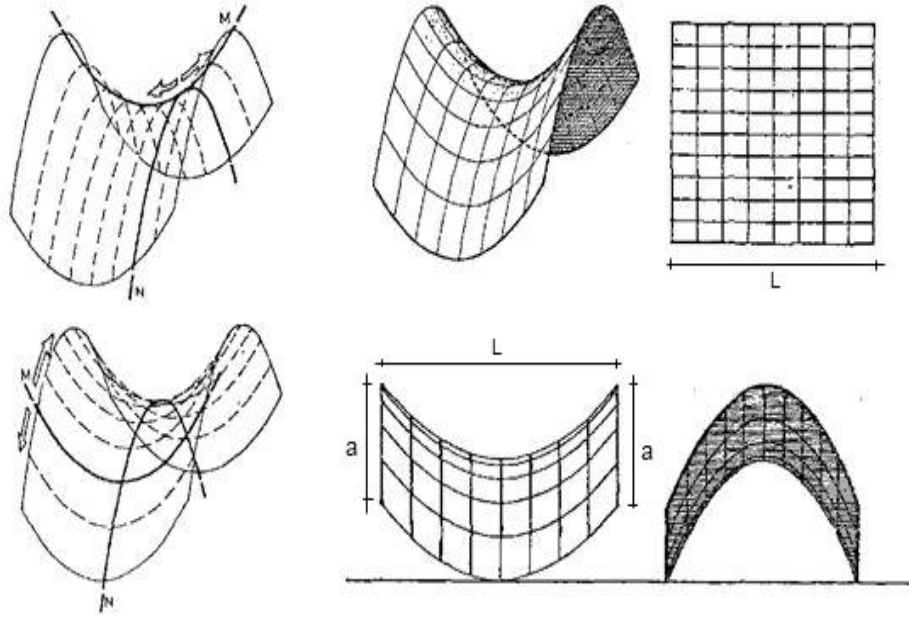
Eğri Kenarlı H.P. Görünüş ve Planı
